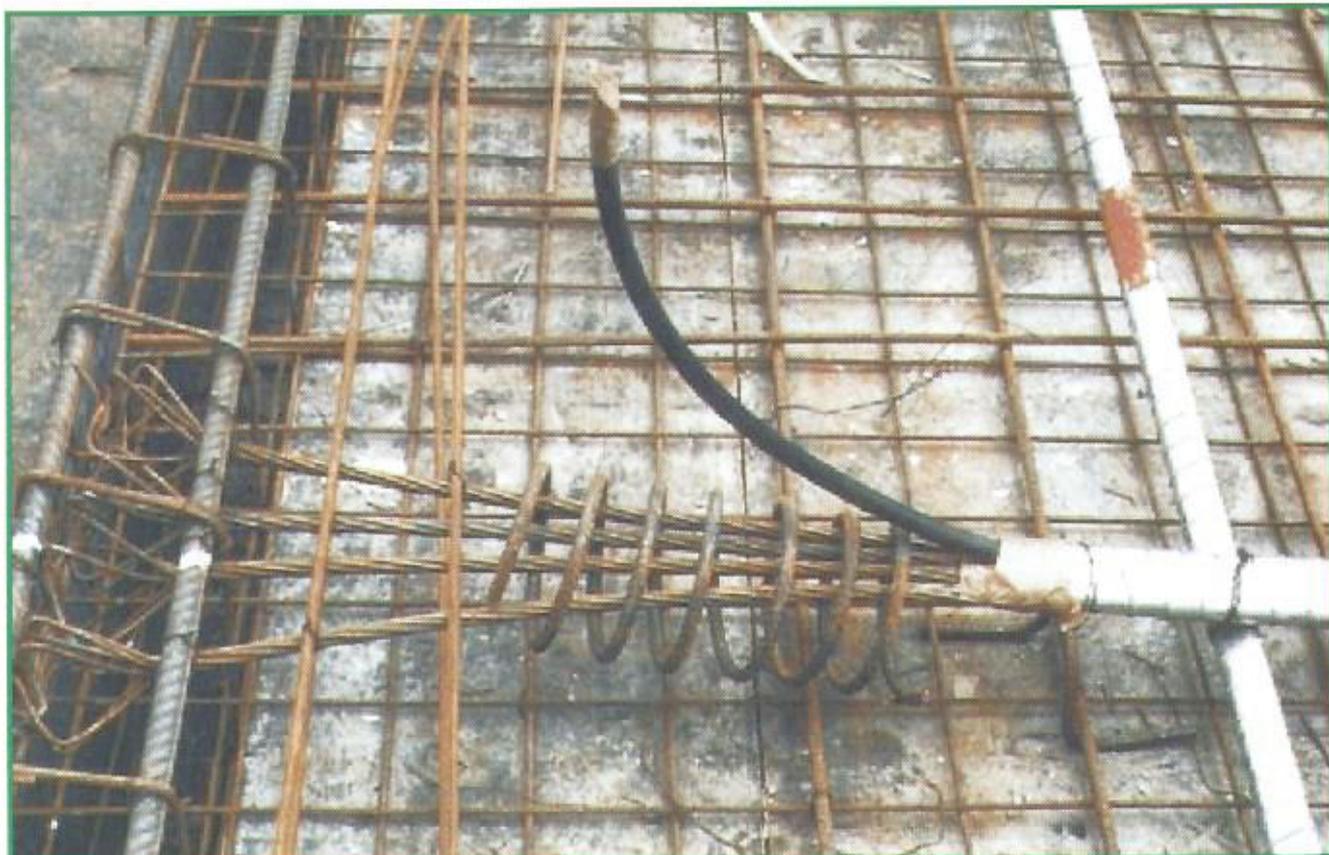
detalhe de purgador e armadura de fretagem junto à ancoragem
